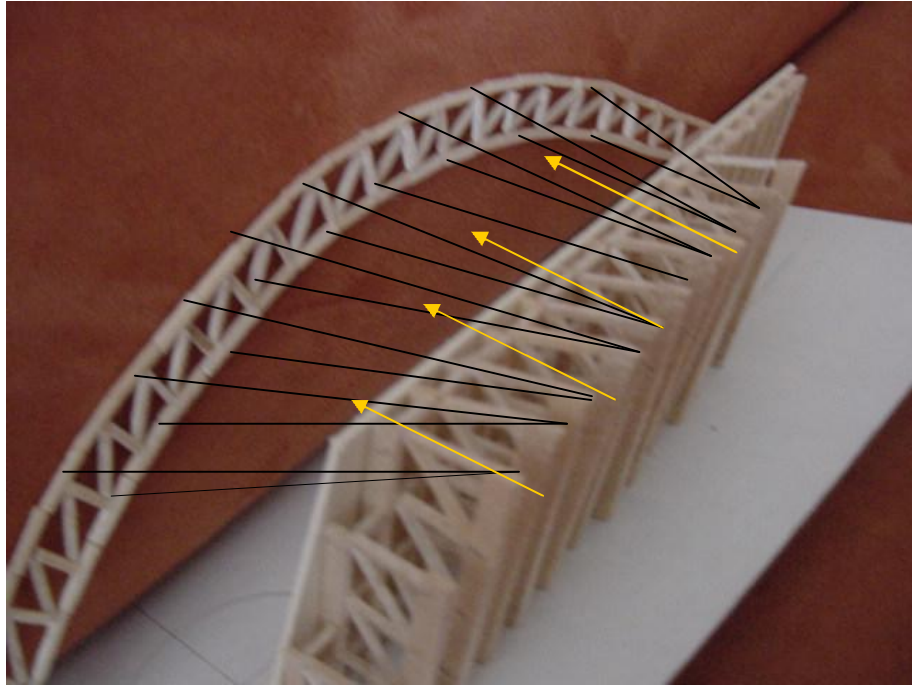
Las líneas amarillas muestran la dirección en que ejercen su fuerza los tensores, desde la estructura original, es decir la inclinada, hacia el elemento que la refuerza.
